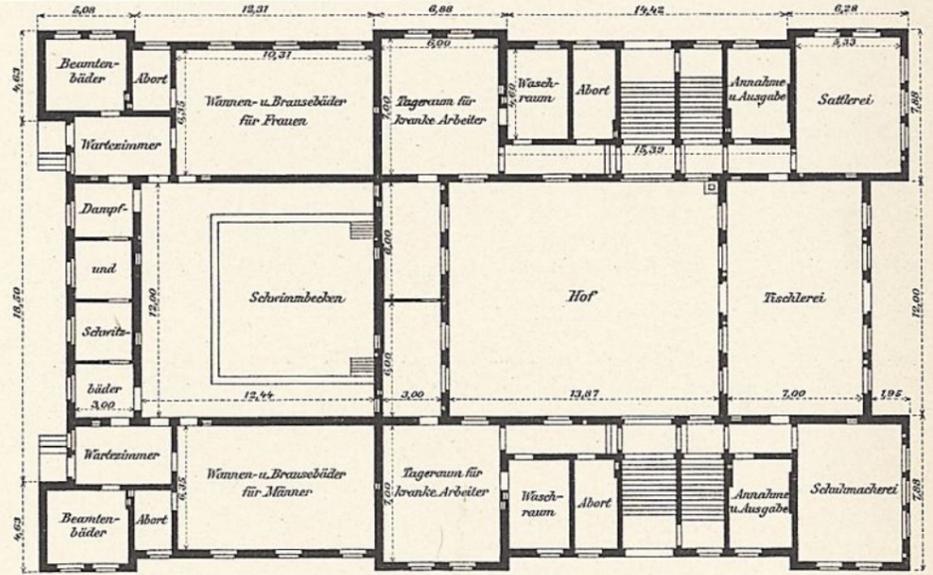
Werkstättengebäude u. Badeanstalt. Erdgeschoß.
